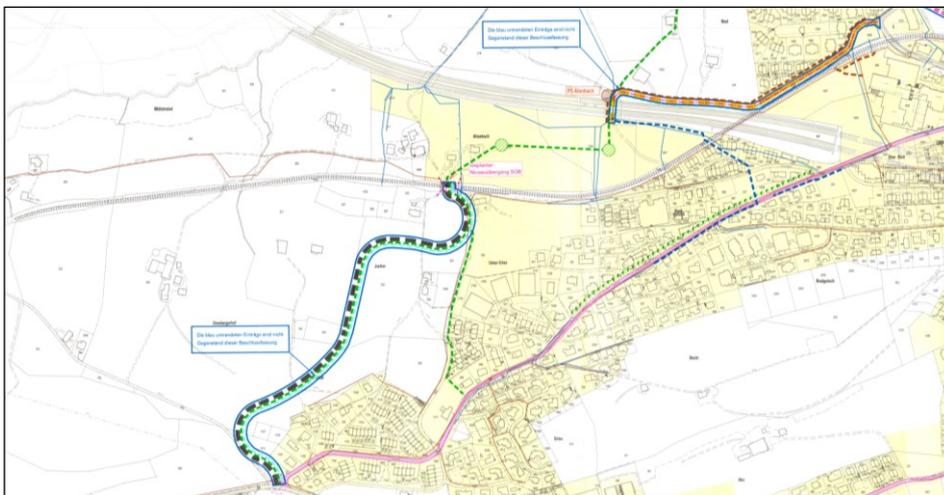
Ausschnitt Erschliessungsplan der Gemeinde Wollerau, RRB Nr. 1069 vom 19.10.2010
